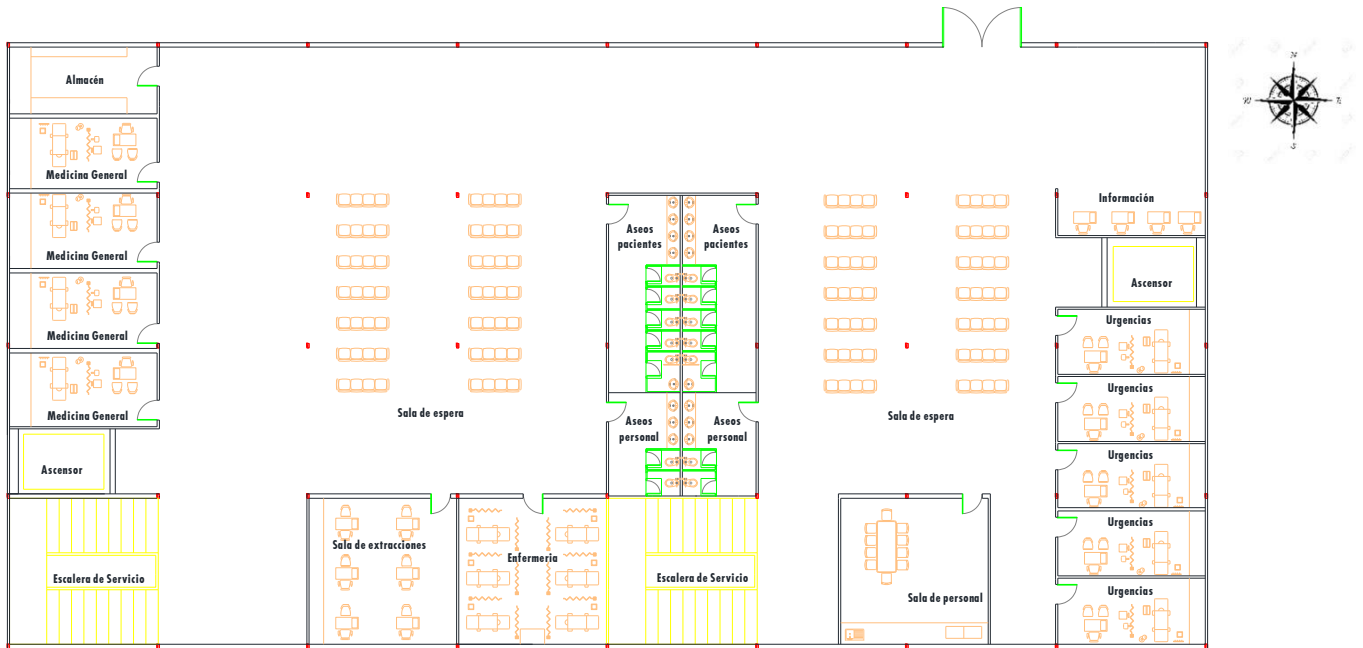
Planta baja. Fuente: AutoCAD (elaboración propia)
